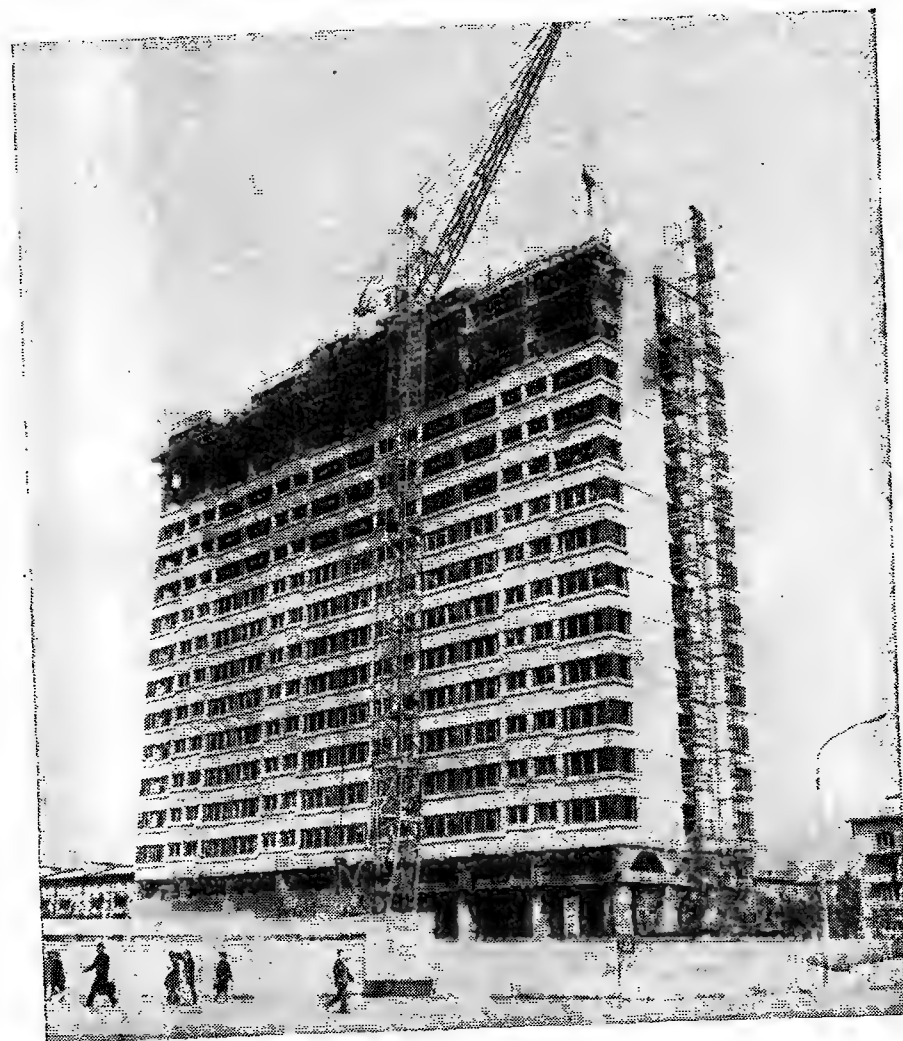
Возведение 22-этажного сборно-монолитного здания в Ленинграде
